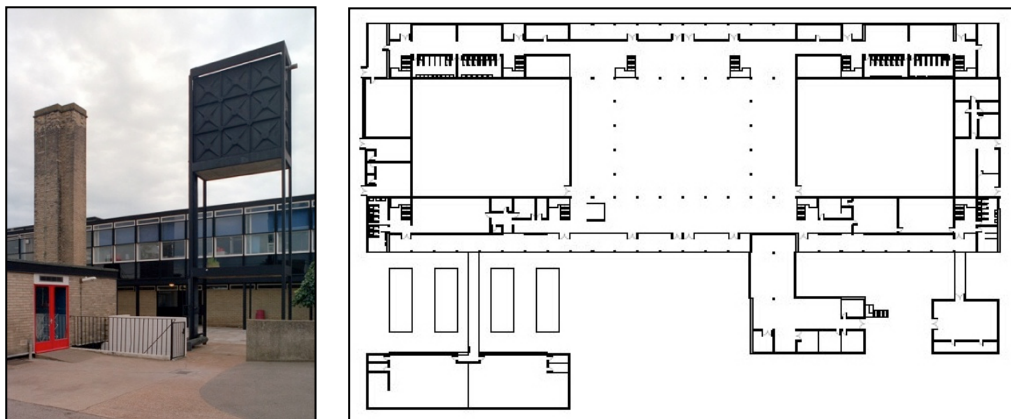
Detall instal·lacions (dipòsit i xemeneia) i planta de l'edifici
